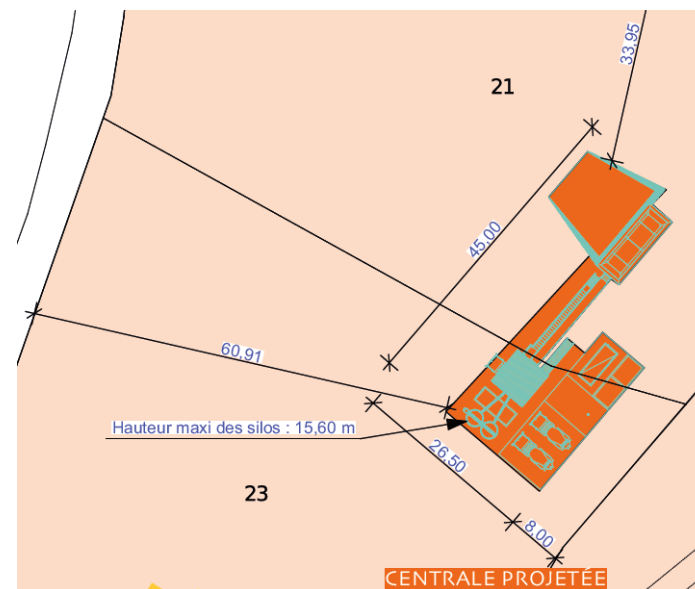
Plan de masse et coupe du projet, source Stéphane PALE, architecte
